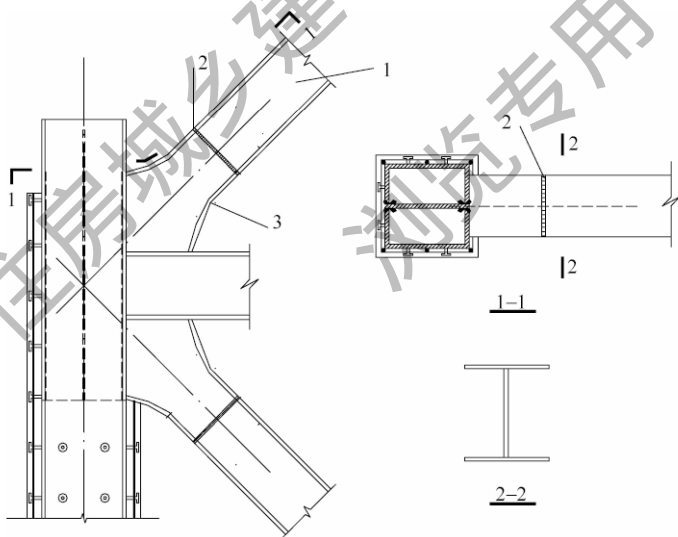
支撑与梁柱焊接连接构造示意
